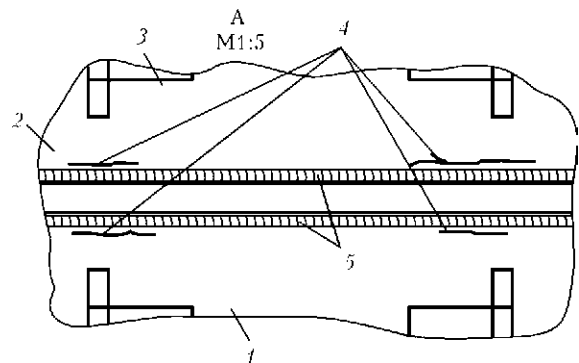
Трещины в зоне сплавления сварного шва диафрагмы: 1-4 — см. на рис. 2; 5 — сварные швы диафрагмы
